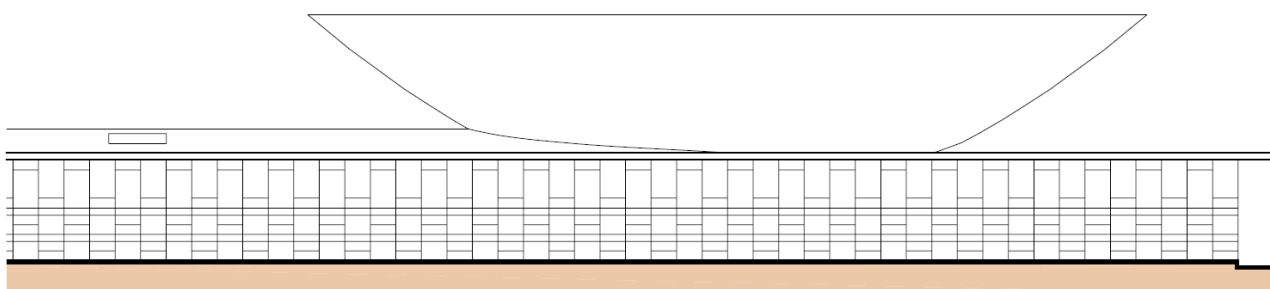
Etapa Projeto – Trecho Fachada Oeste – Cúpula da Câmara dos Deputados. 1958.
